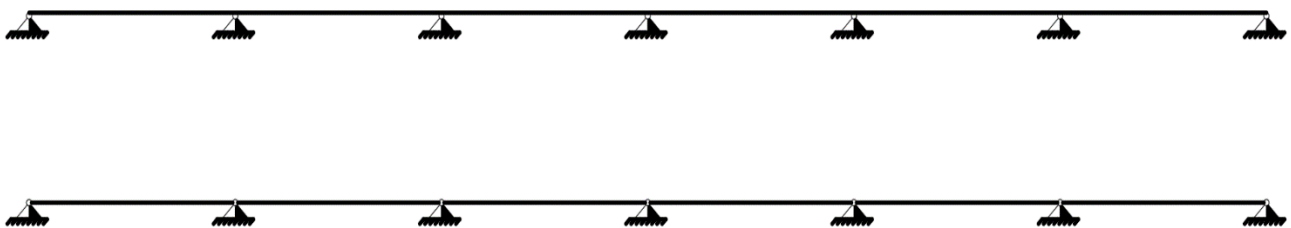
Modellizzazioni strutturali differenti del solaio. In alto, lo schema corrispondente al caso di progetto (lamiera appoggiata sulle travi e connettori sismici di collegamento tra trave e solaio); nel secondo caso è rappresentato lo schema utilizzato nei calcoli a vantaggio di sicurezza.
